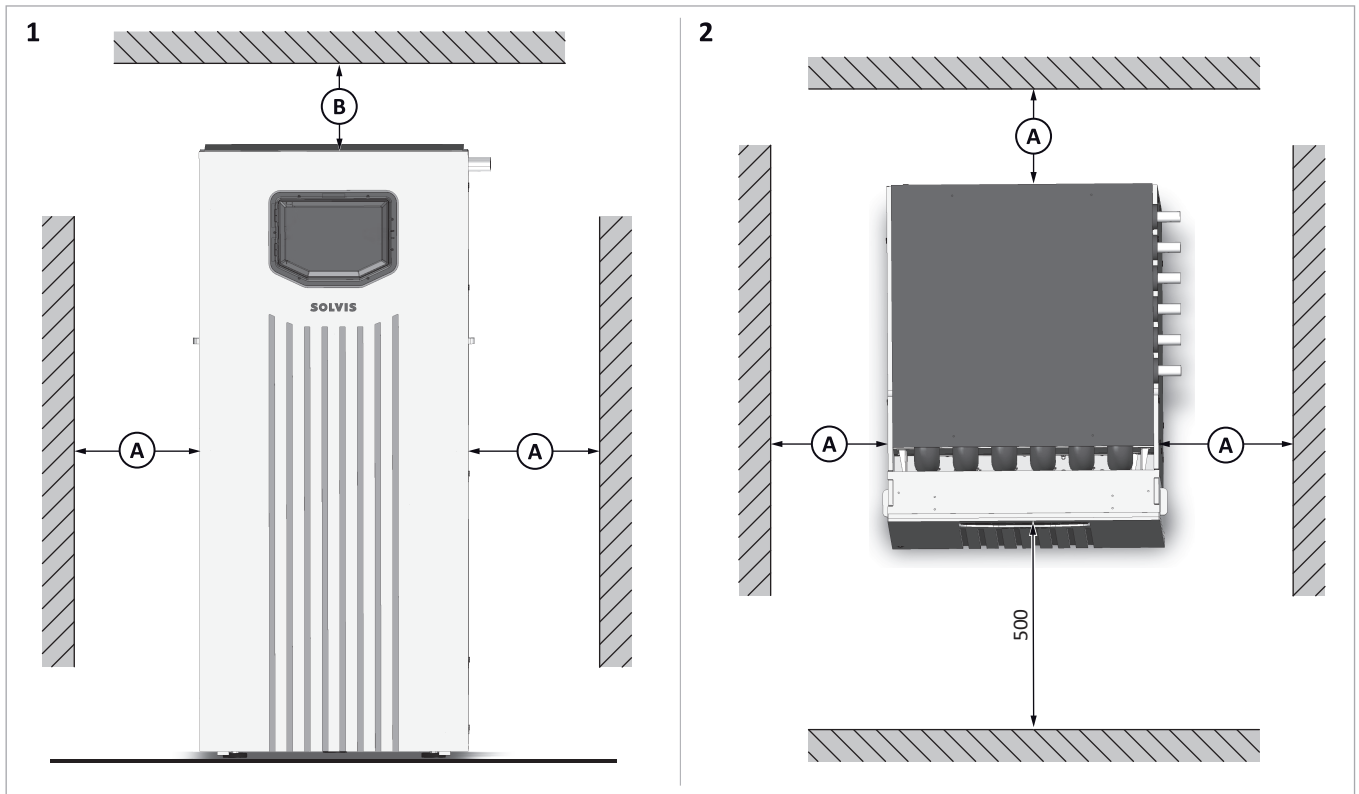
Mindestabstände SolvisLeo (alle Maße in mm)
